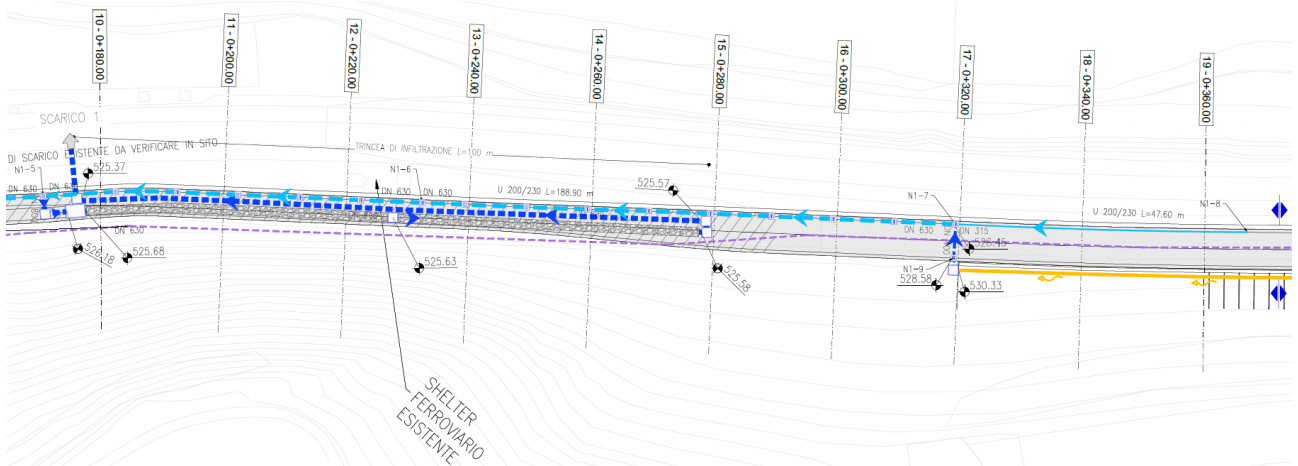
Estratto dalla "Planimetria idraulica" di progetto esecutivo (codifica: IBOU1BEZZP8NV0420001)
